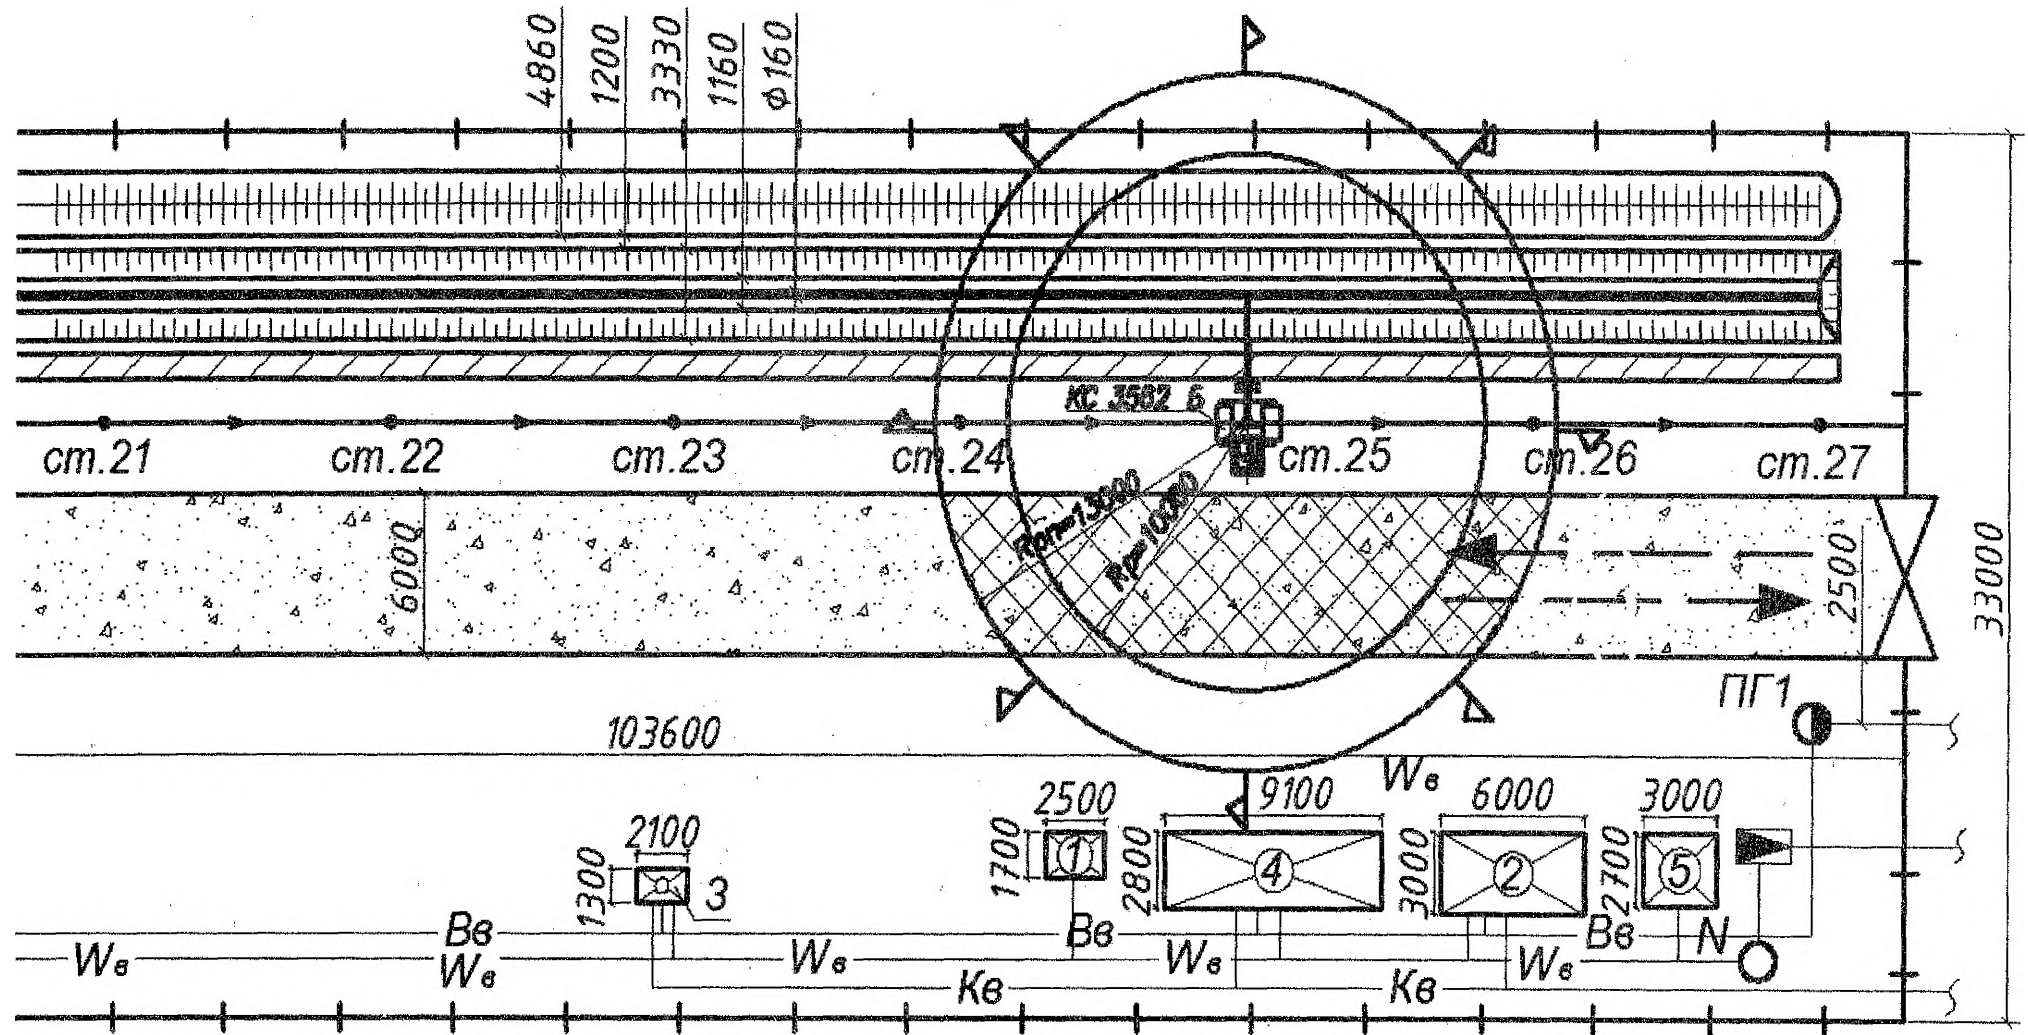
Фрагмент стройгенплана строительства водоводов 1-го подъема
